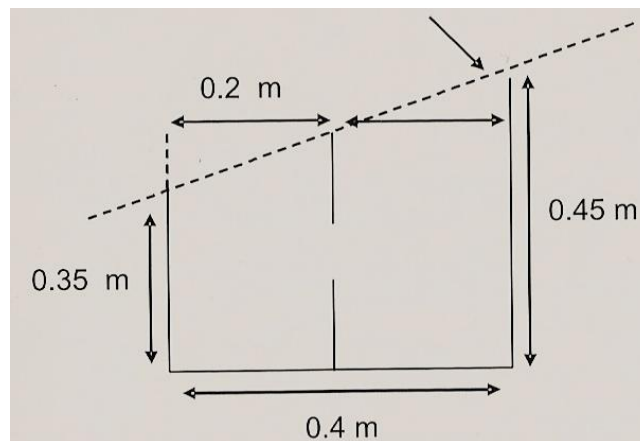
Sección transversal del diseño de una presa en terreno con pendiente.
